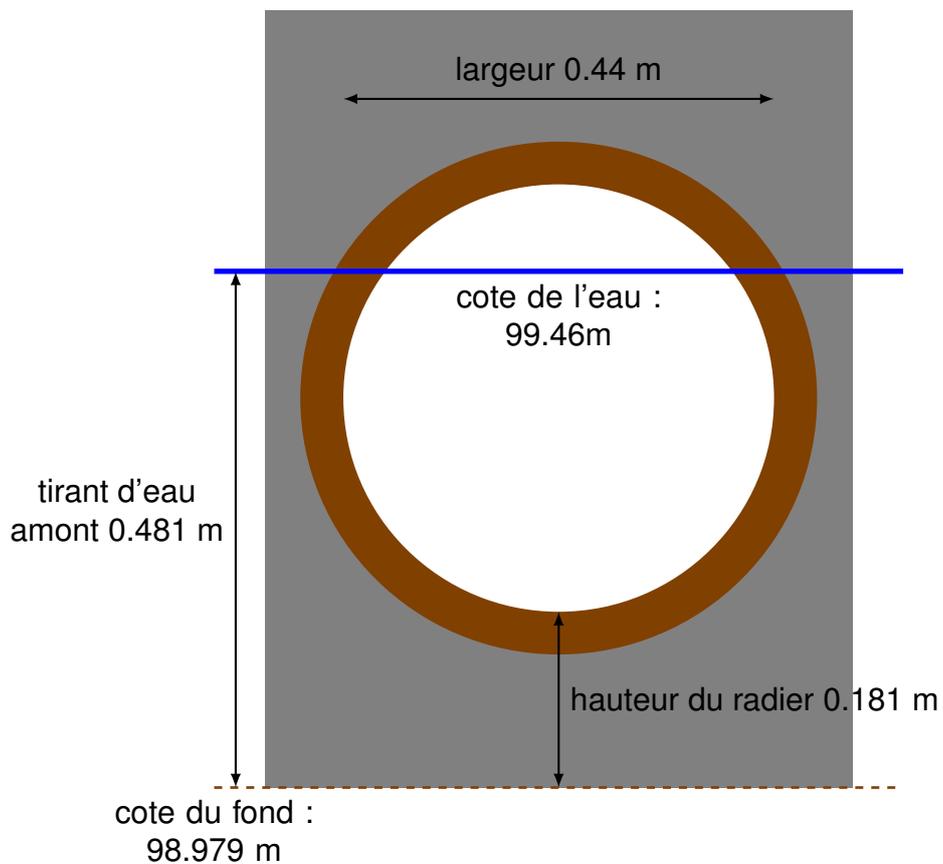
Coupe transversale de la buse située à l'aval de la prise d'eau du canal rive gauche
